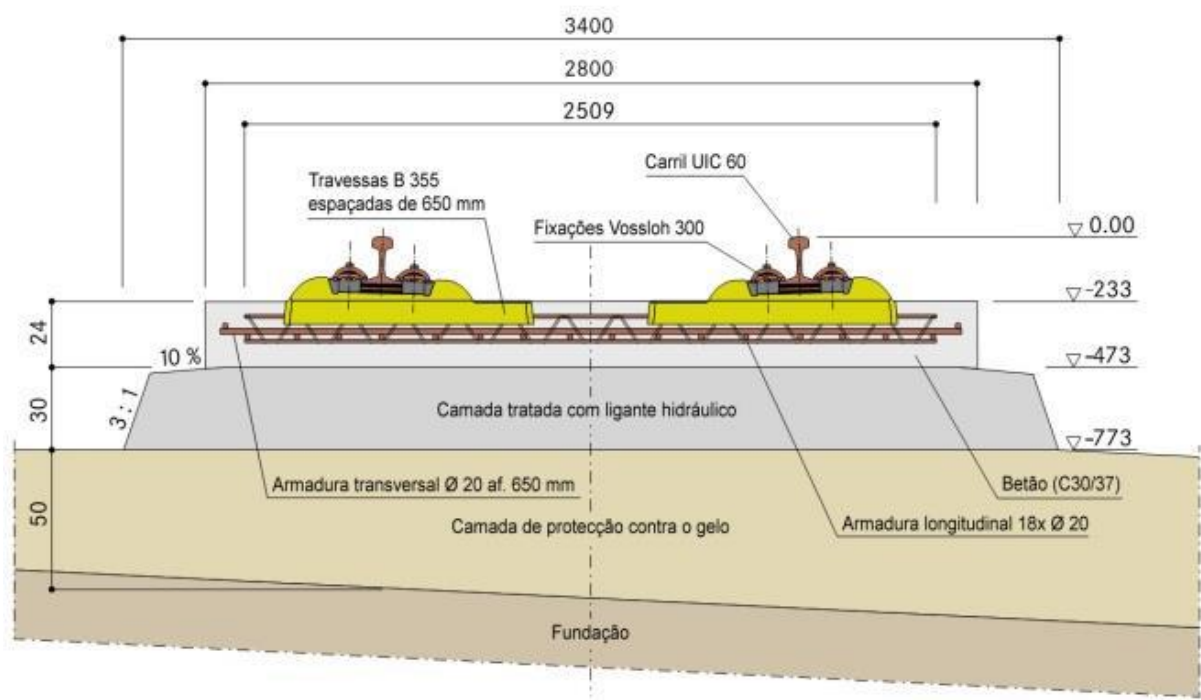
Exemplo de via não balastrada em laje (Paixão & Fortunato, 2009)
